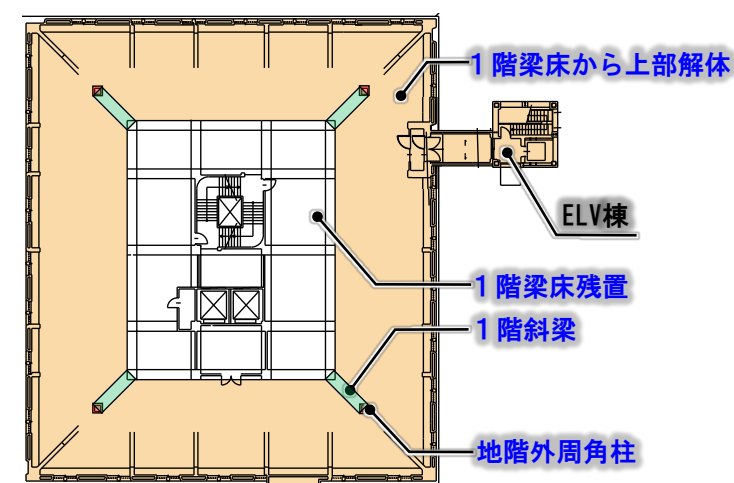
大天守解体部分1階平面図(ELV棟含)
